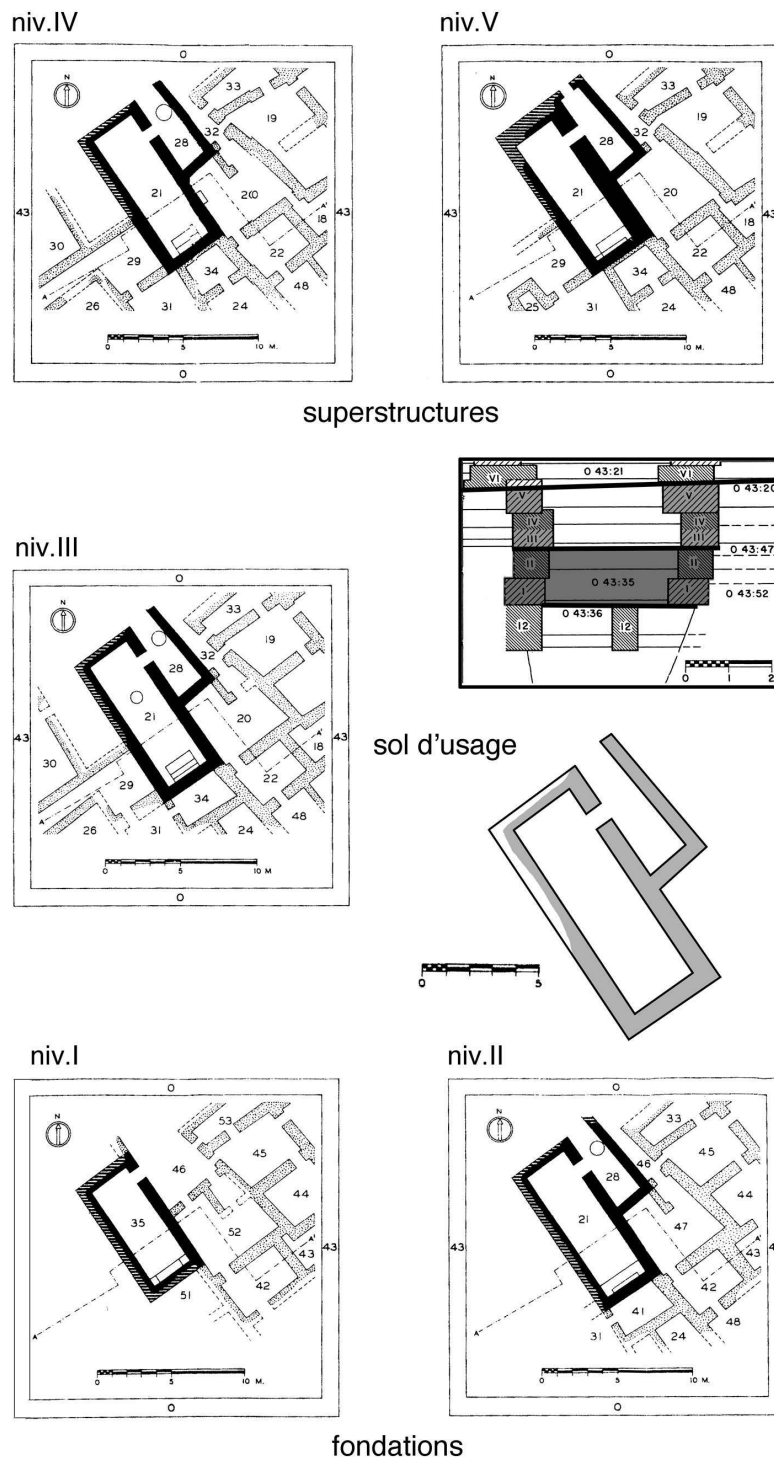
Le Petit temple de la couche architecturale C : en grisé le plan du temple au niveau du sol d'usage
